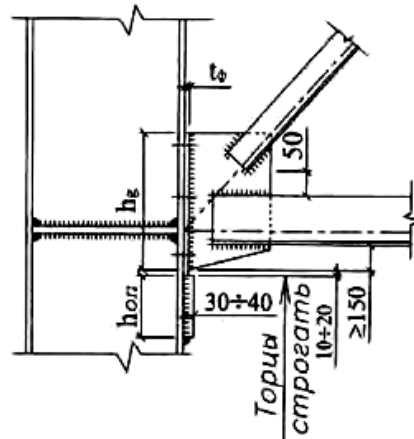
Опорный узел фермы в уровне нижнего пояса
